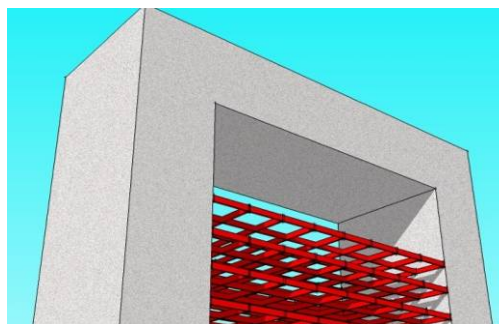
Esquema Estrutural projetado com vigas treliçadas.
